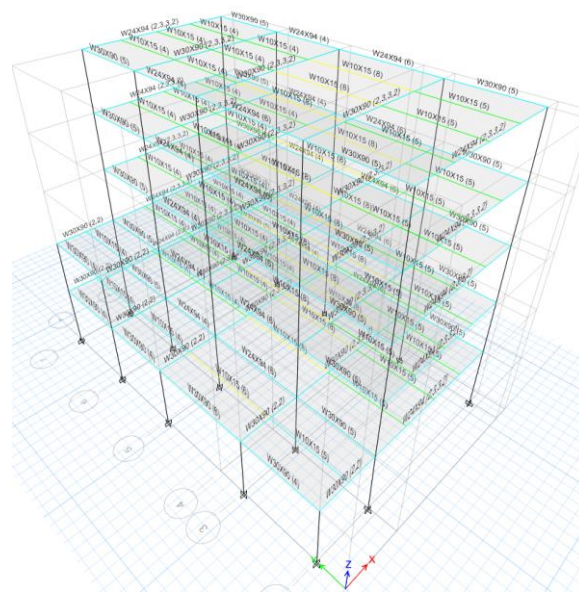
Análisis de elementos en vigas y placa colaborante
